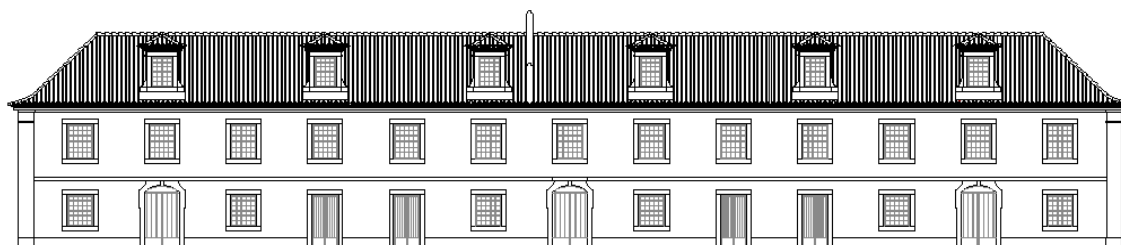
“Alçado Nascente – Praça Marquês de Pombal.”
